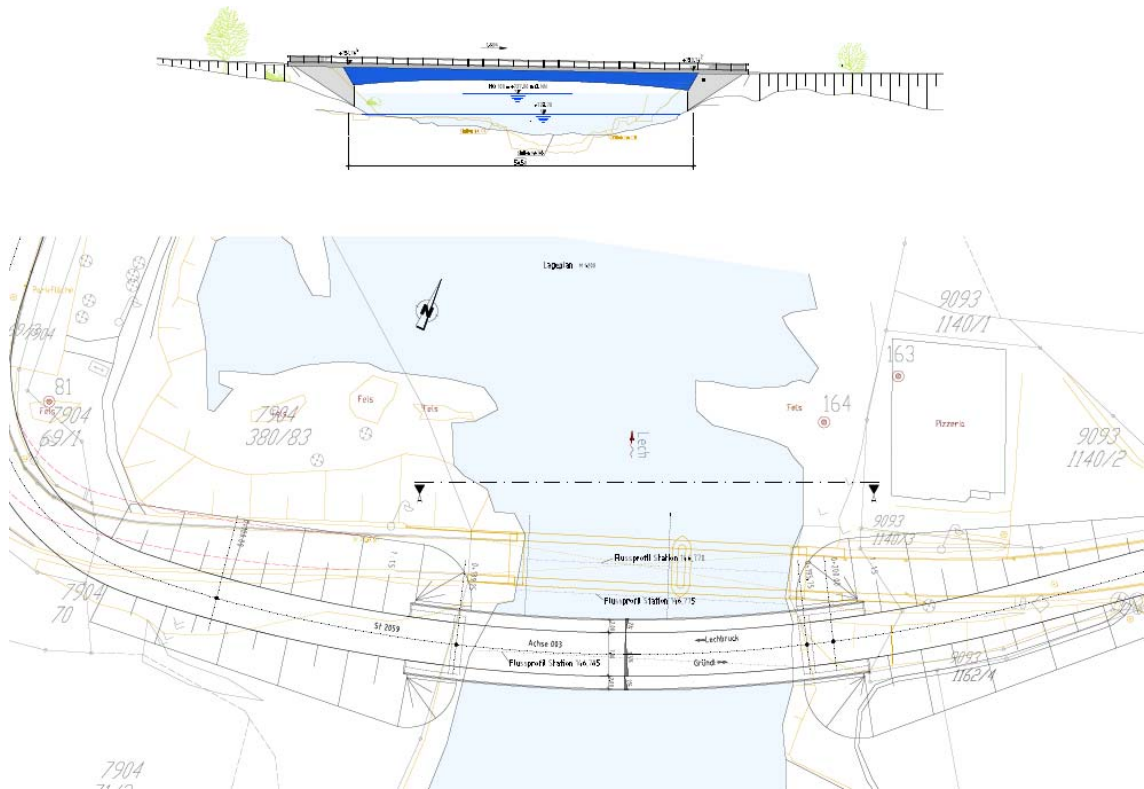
Variante 2 in Grundriss und Ansicht
